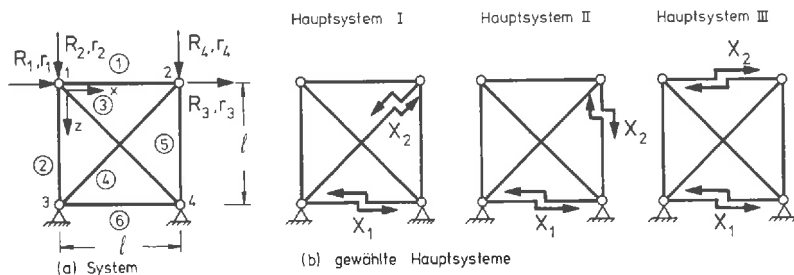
Ebenes Fachwerk mit zulässigen Hauptsystemen
